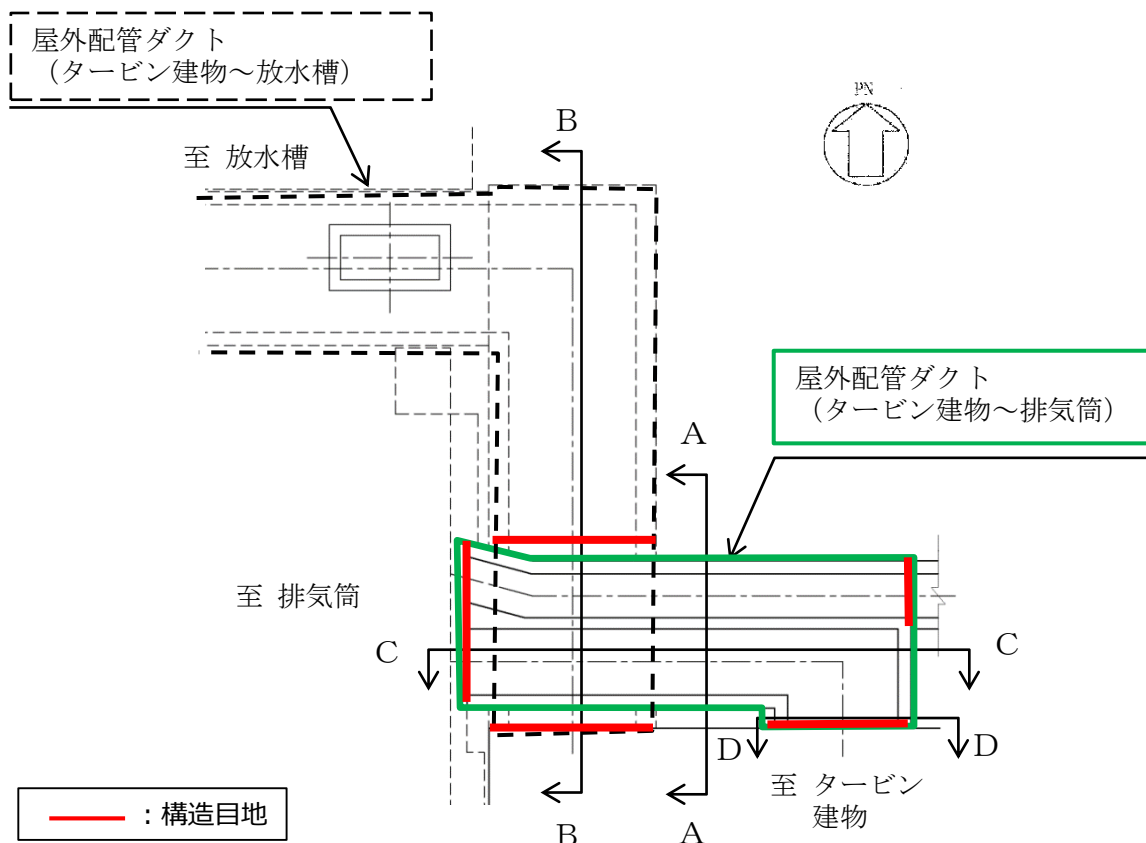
屋外配管ダクト（タービン建物～排気筒） 平面図
